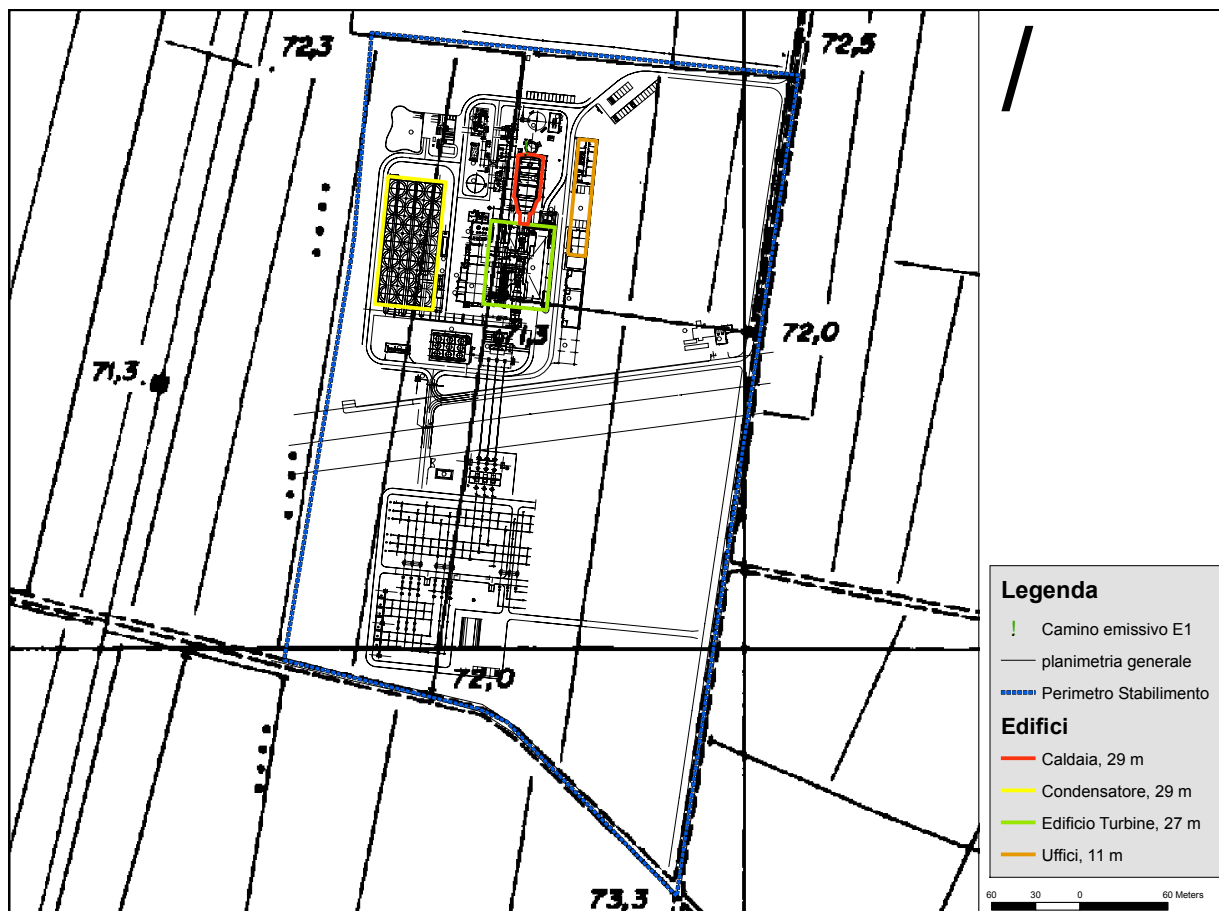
Effetto “Building downwash”: edifici considerati
